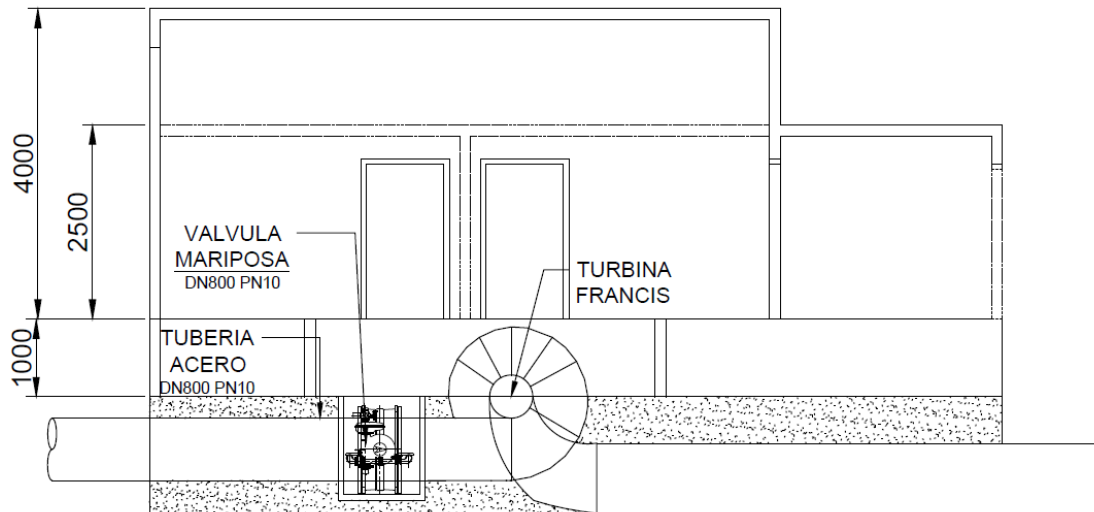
8. Plano casa de máquinas vista lateral. Fuente: Creación propia diseñada en Autocad.
